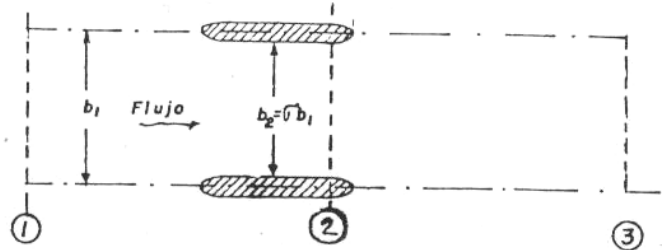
a Geometría en planta de pilas en dirección del flujo.
